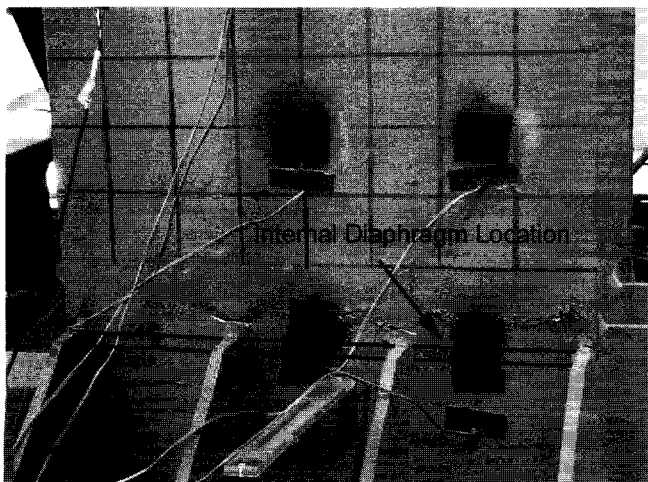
외측 리브 용접선단부(weld toe)에서 발생한 균열(C500)
